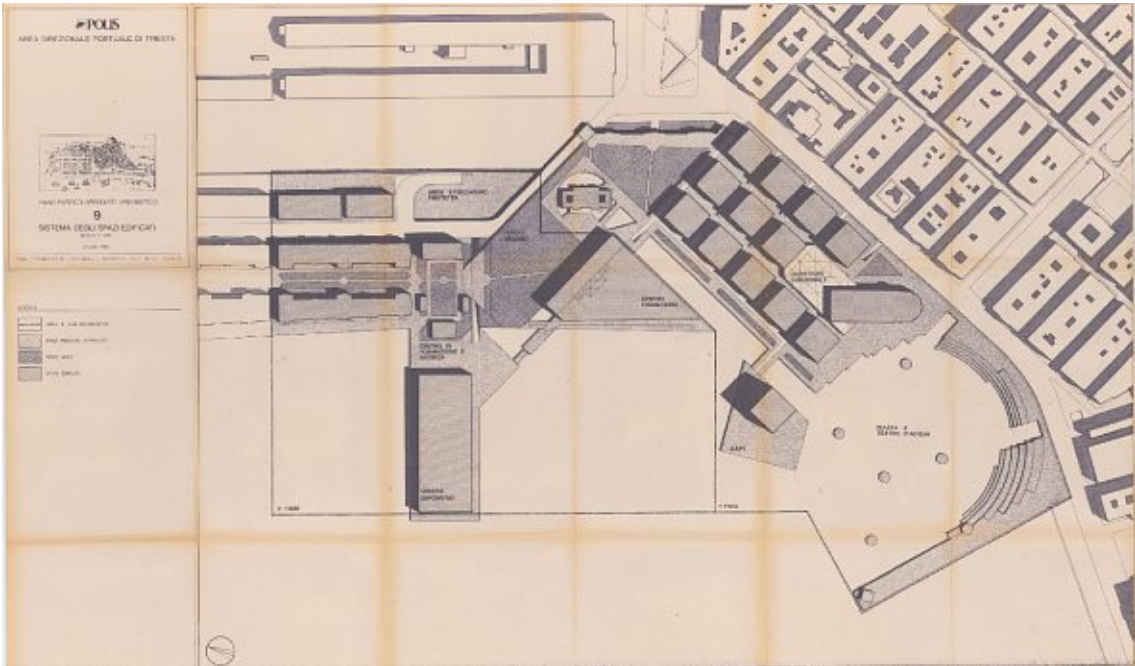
Lageplan des vom Masterplan „Progetto Polis“ betroffenen Areal. In diesem Plan sind die zwei Areale der ersten und zweiten Konstruktionsphasen. Nicolò Savarese, 1988.
